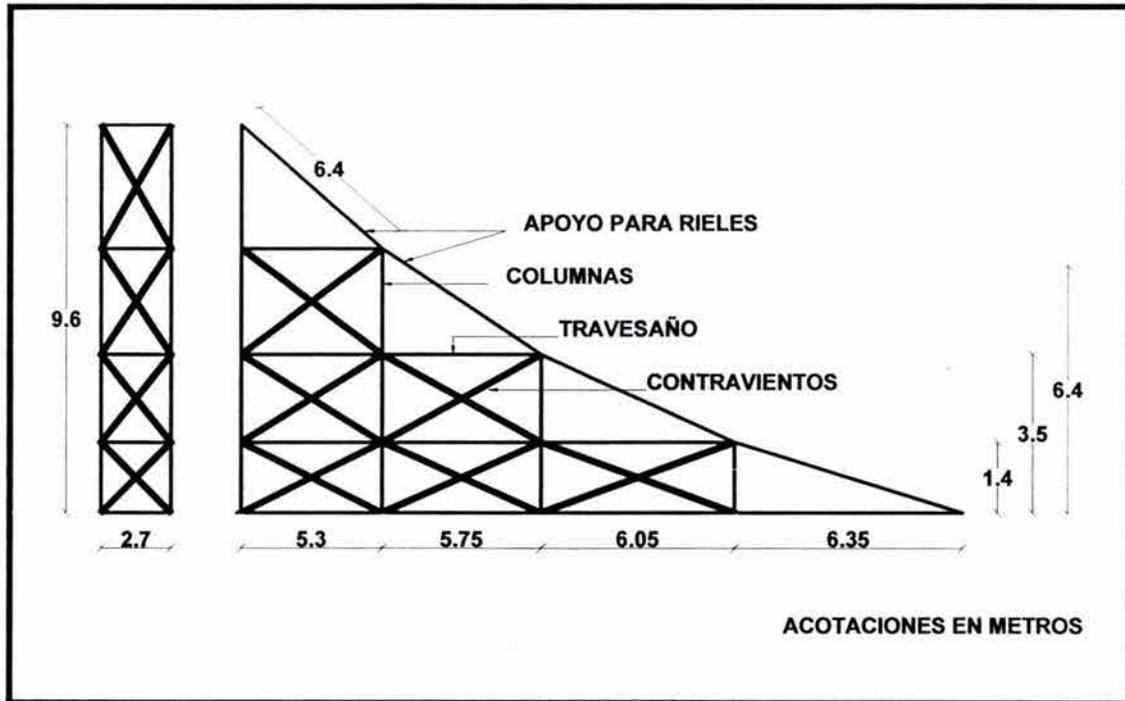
VISTA FRONTAL DE LAS COLUMNAS DE APOYO
